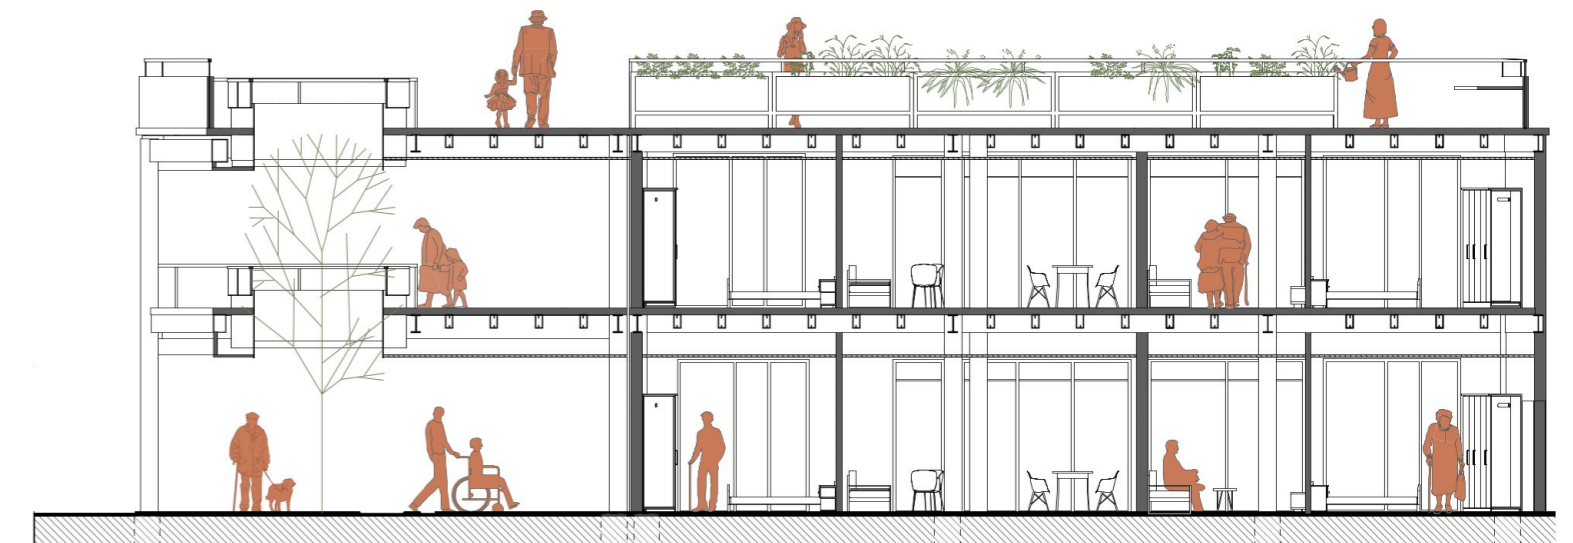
Corte longitudinal D-D, bloque C. Autoría propia.
